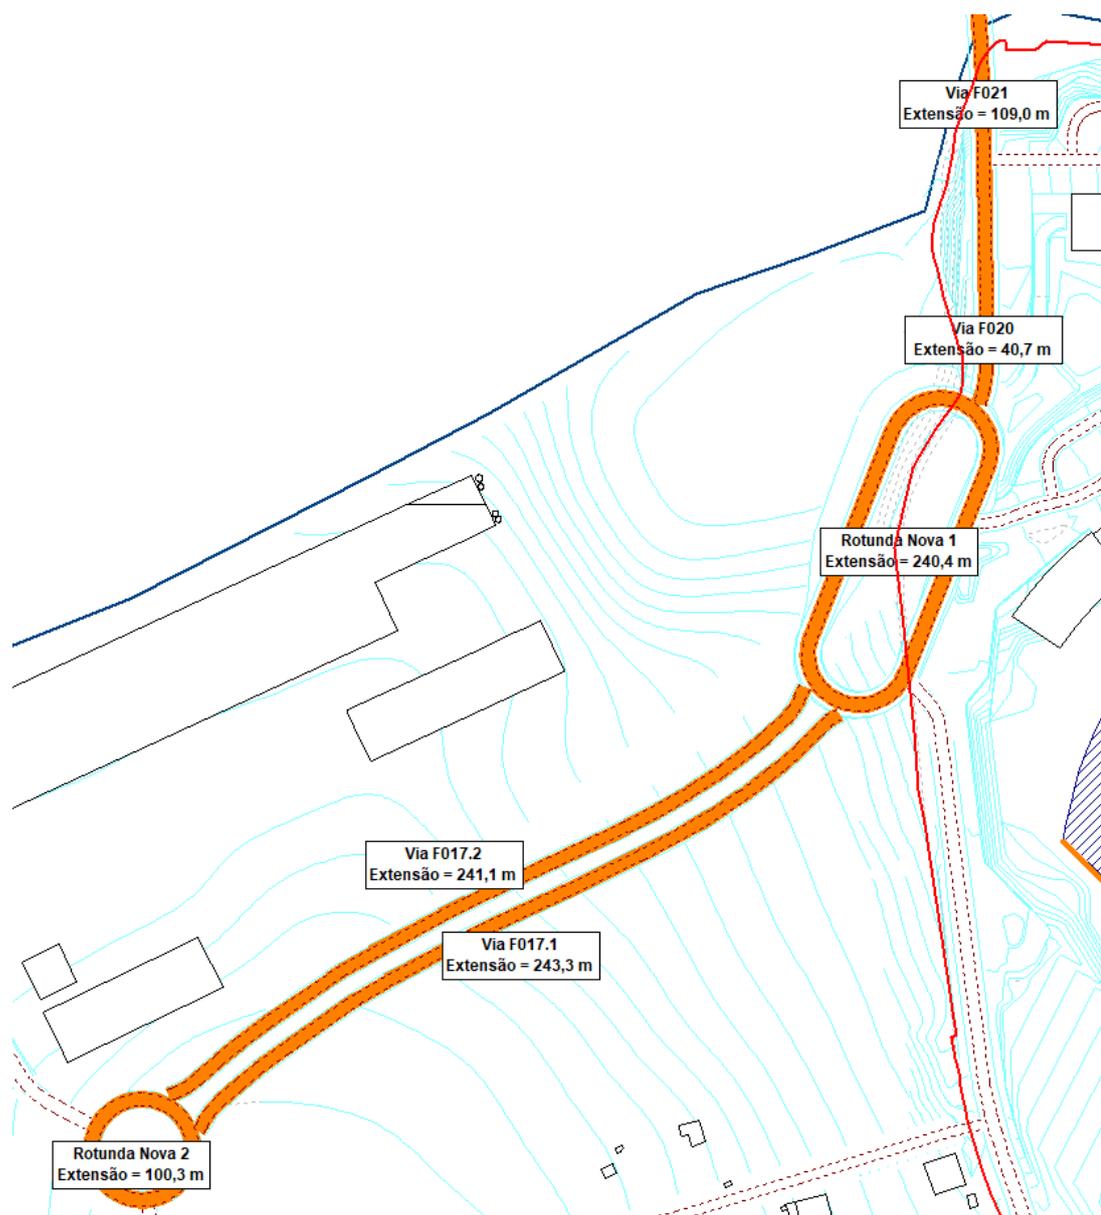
Descrição das medidas de minimização propostas para o Cenário Com Plano e Com Variante
